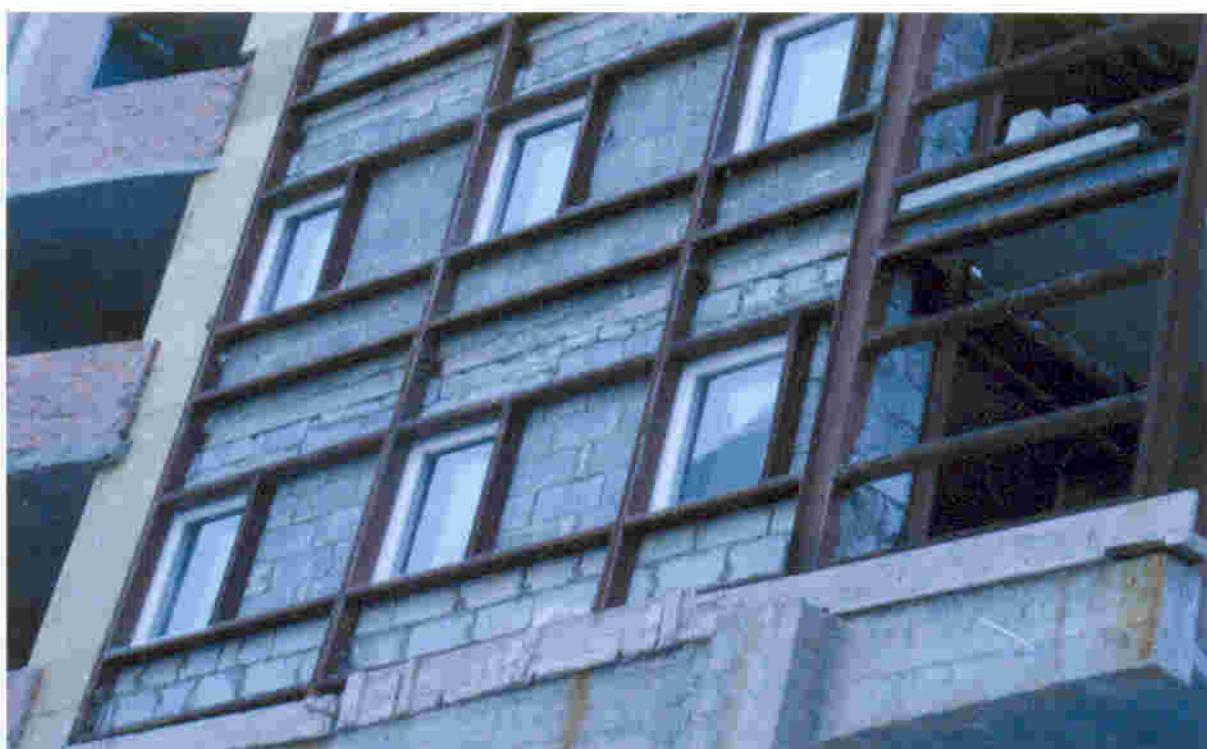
Стена здания, подготовленная для монтажа вентилируемого фасада. Оконные проемы «обрамлены» стальными швеллерами
